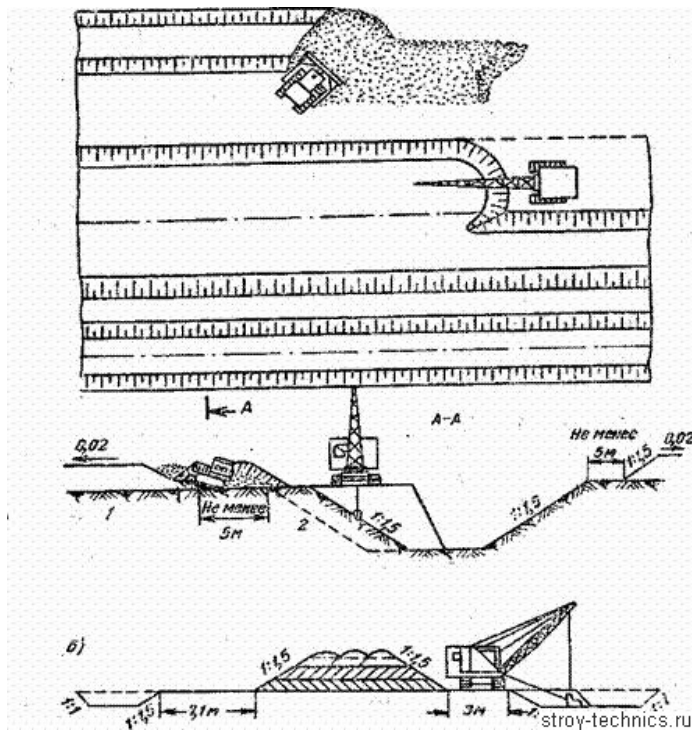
Схема работы экскаватора с драглайном а - разработка выемки в отвал; б - схема отсыпки насыпи из резерва; 1 - кавальер; 2 - откос выемки
